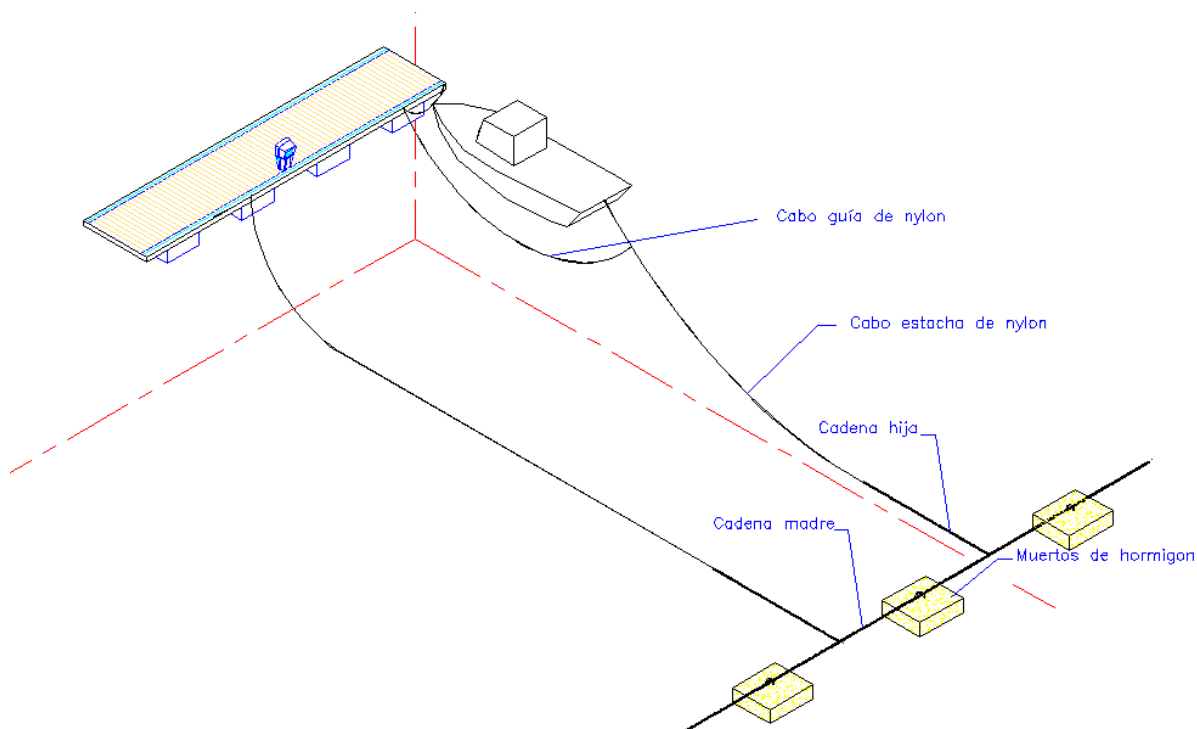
Disposición tipo tren de fondeo para embarcaciones
